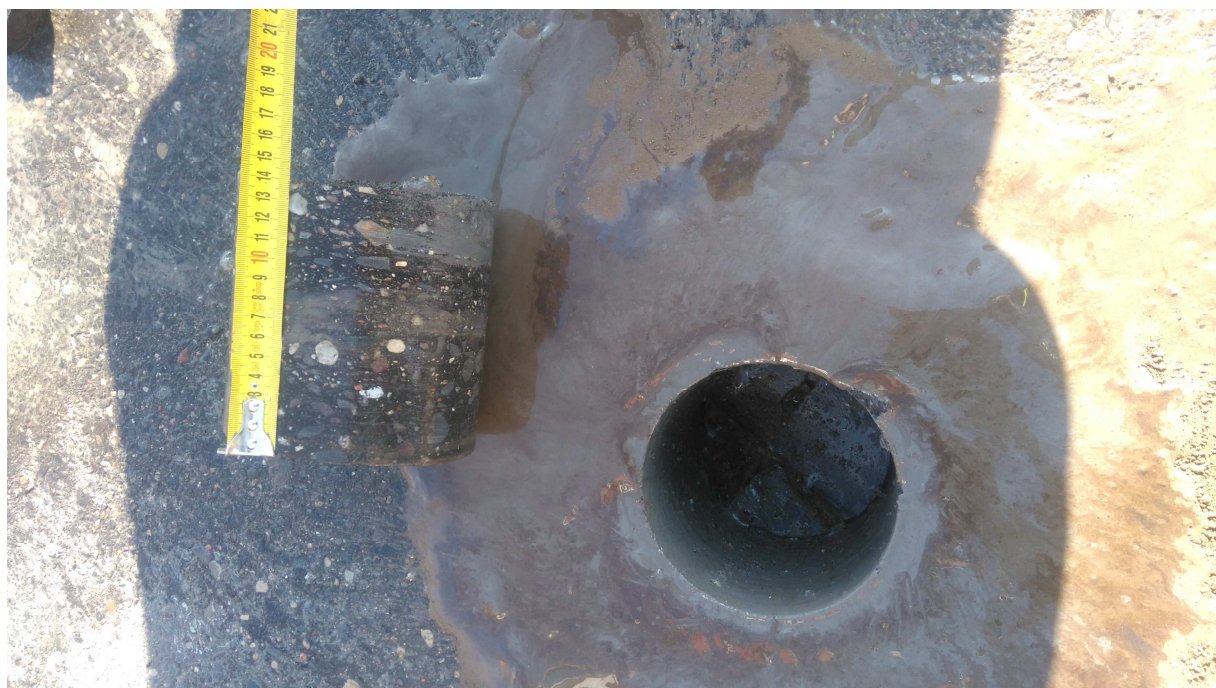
Profil konstrukcji nawierzchni w punkcie badawczym nr 5
